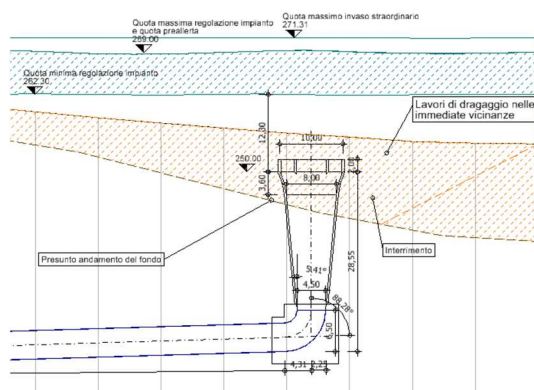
Sezione trasversale delle bocche di presa e restituzione (estratto Tavola PD-EP.21.2 del Progetto Definitivo).
